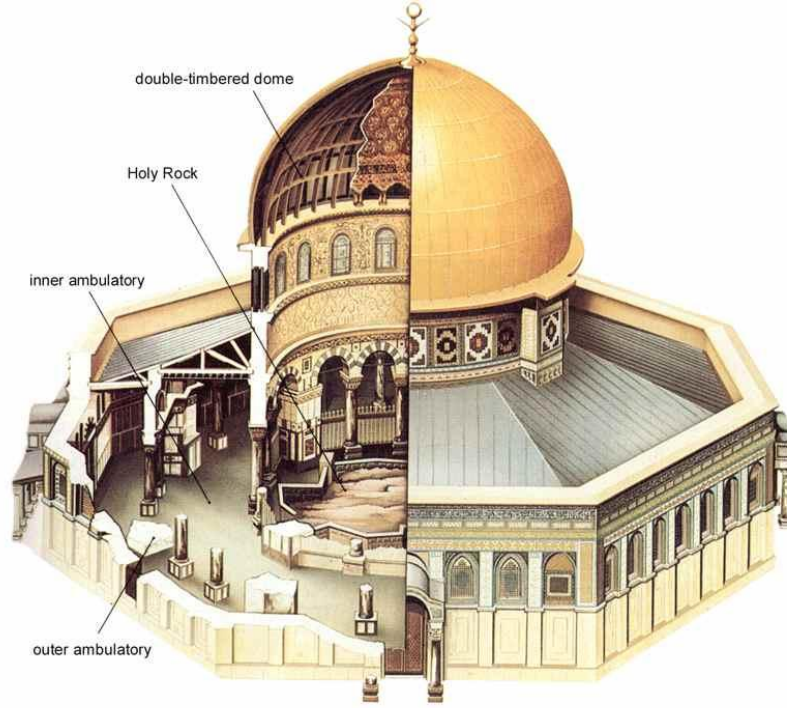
Kübbet-Üs-Sahra'nın dış görünüşü (Dome of The Rock, b.t)
